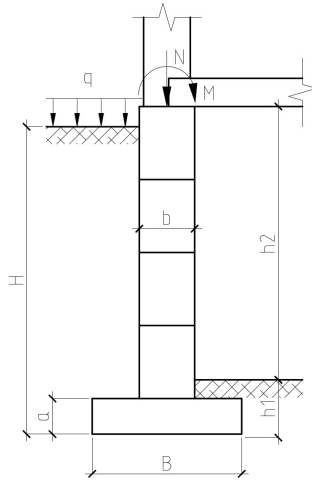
Схема массивной наружной стены подвала из сборных бетонных блоков
